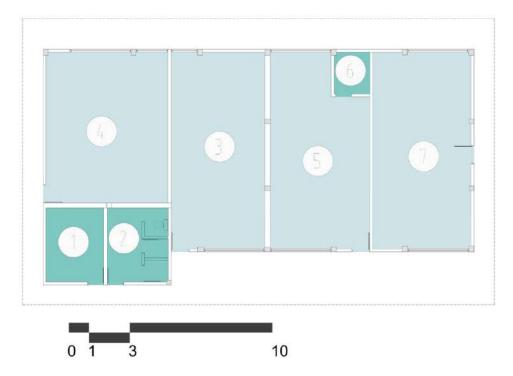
Planta 1 Bloque 57. Fuente: Equipo de diagnóstico.
